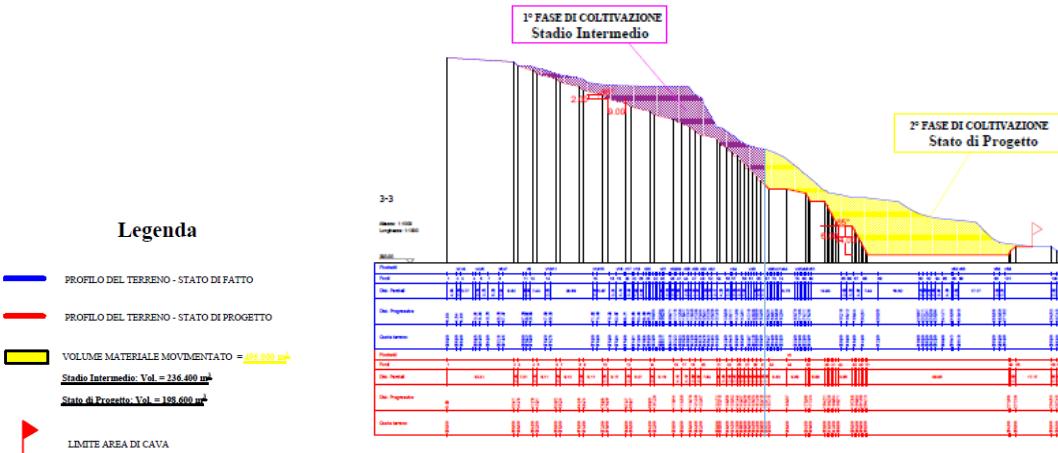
SEZIONE TIPO DI SOVRAPPOSIZIONE
